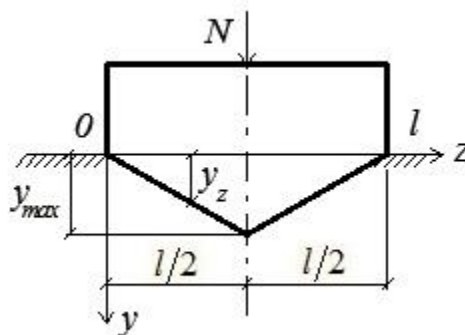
Фундамент с очертанием подошвы в форме плоского клина
